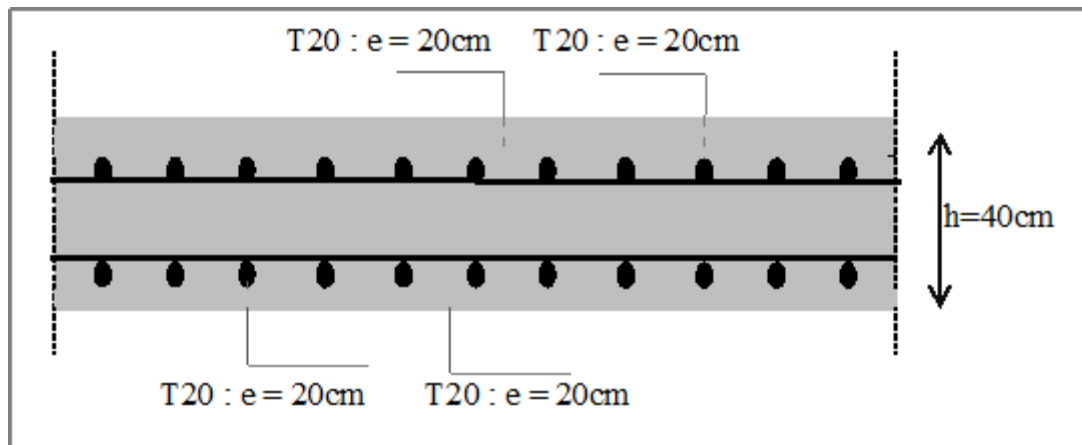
Ferrailage de la dalle du radier sens y-y
